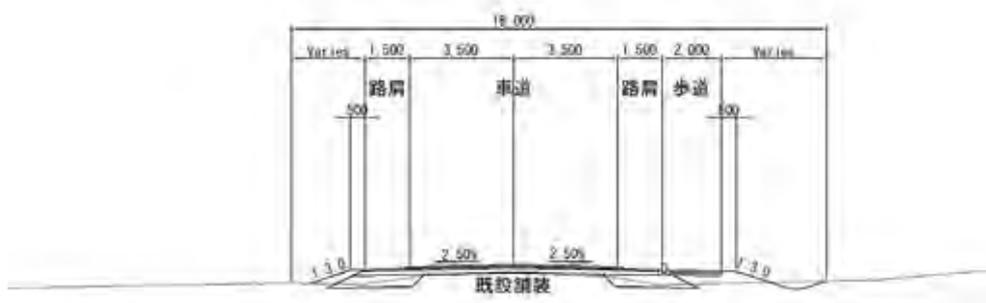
現地側による舗装施工済み区間の標準横断面図
